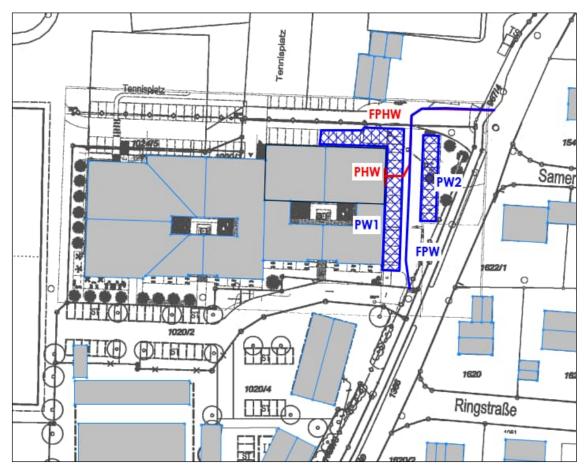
Lageplan mit Darstellung der relevanten Schallquellen des Parkverkehrs der Wohnanlage
